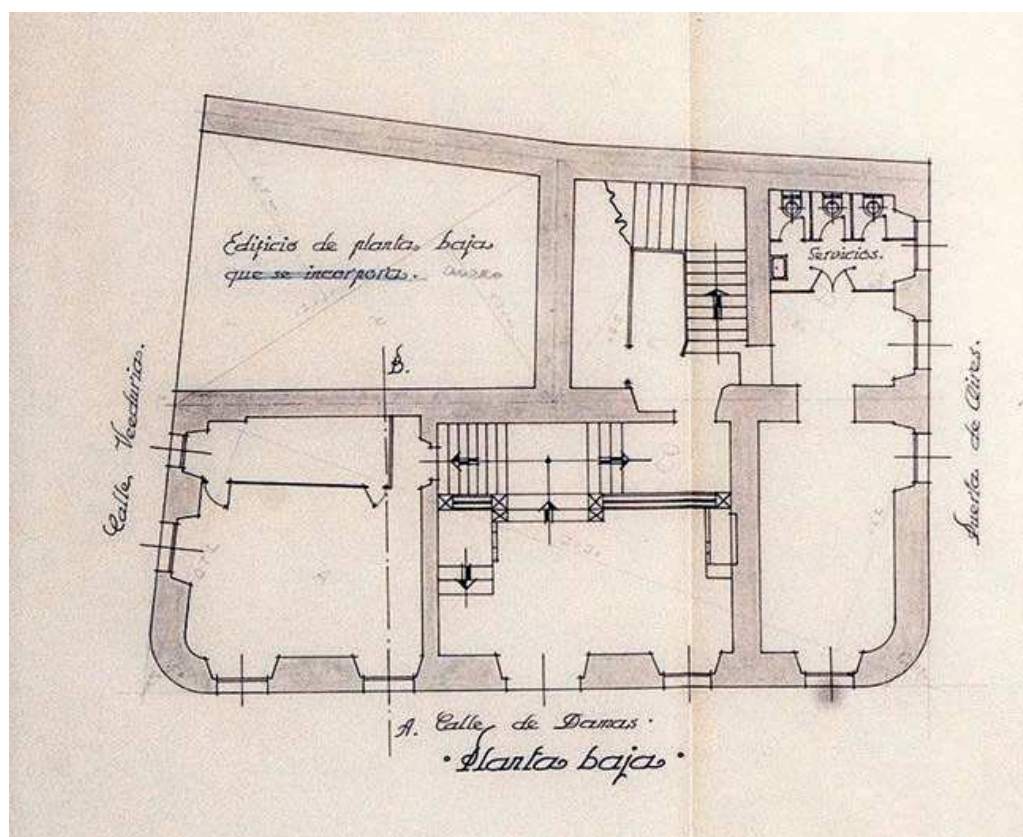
Planta baja de la Casa Cornide en 1951. Peregrín Estellés. AMC. Fondo Tenreiro, caja 26 (1). Foto José Caruncho.
